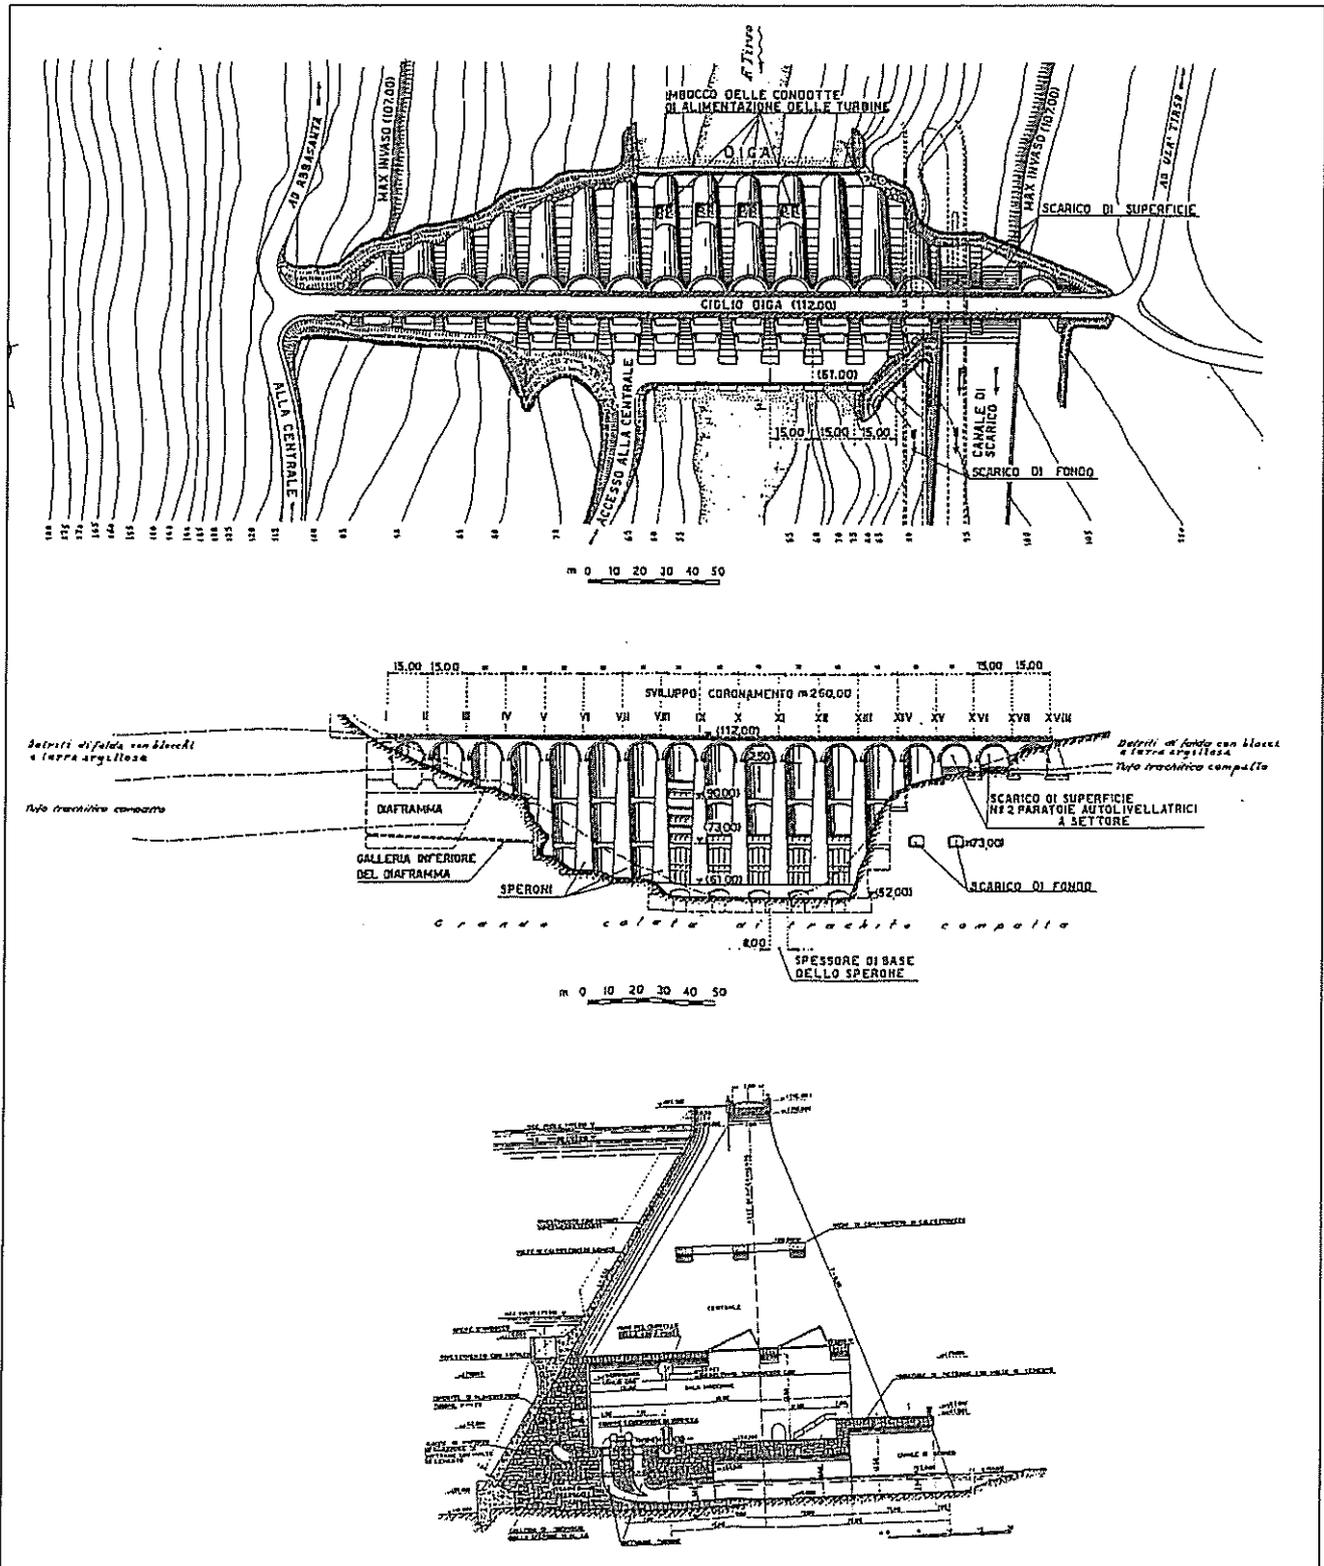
Diga di S. Chiara: Planimetria - Vista da valle - Sezione tipo.
